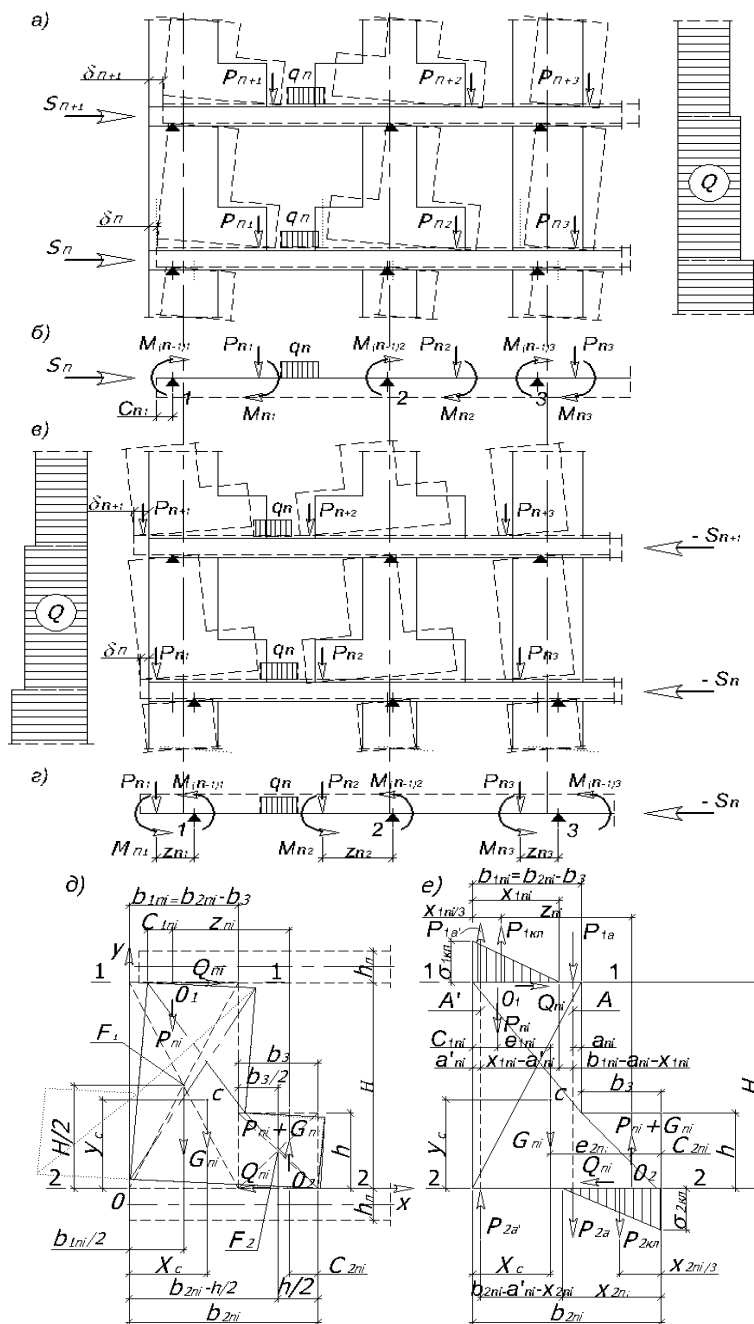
Расчетно-аналитическая модель (а, в, д, е) и схема (б, г) АС поясов каменных стен без вертикальной разрезки с учетом работы подоконных частей в их плоскости: тип 1 без вертикального армирования (д); тип 2 с вертикальным армированием (е) [рис. автора].
